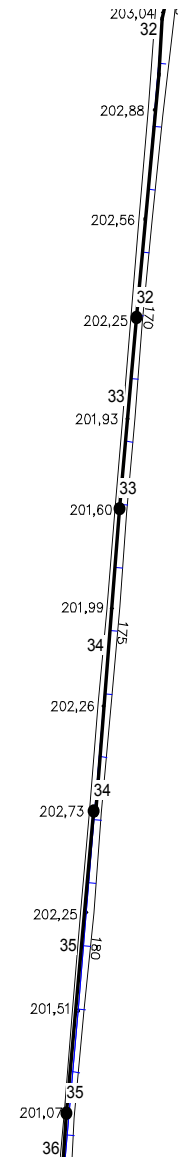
EPANET parcial 4 – Rede de Lajes 2
